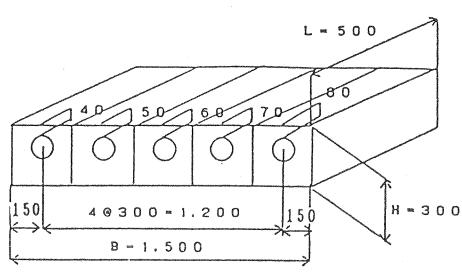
蒸気養生による縦ひび割れ試験供試体
